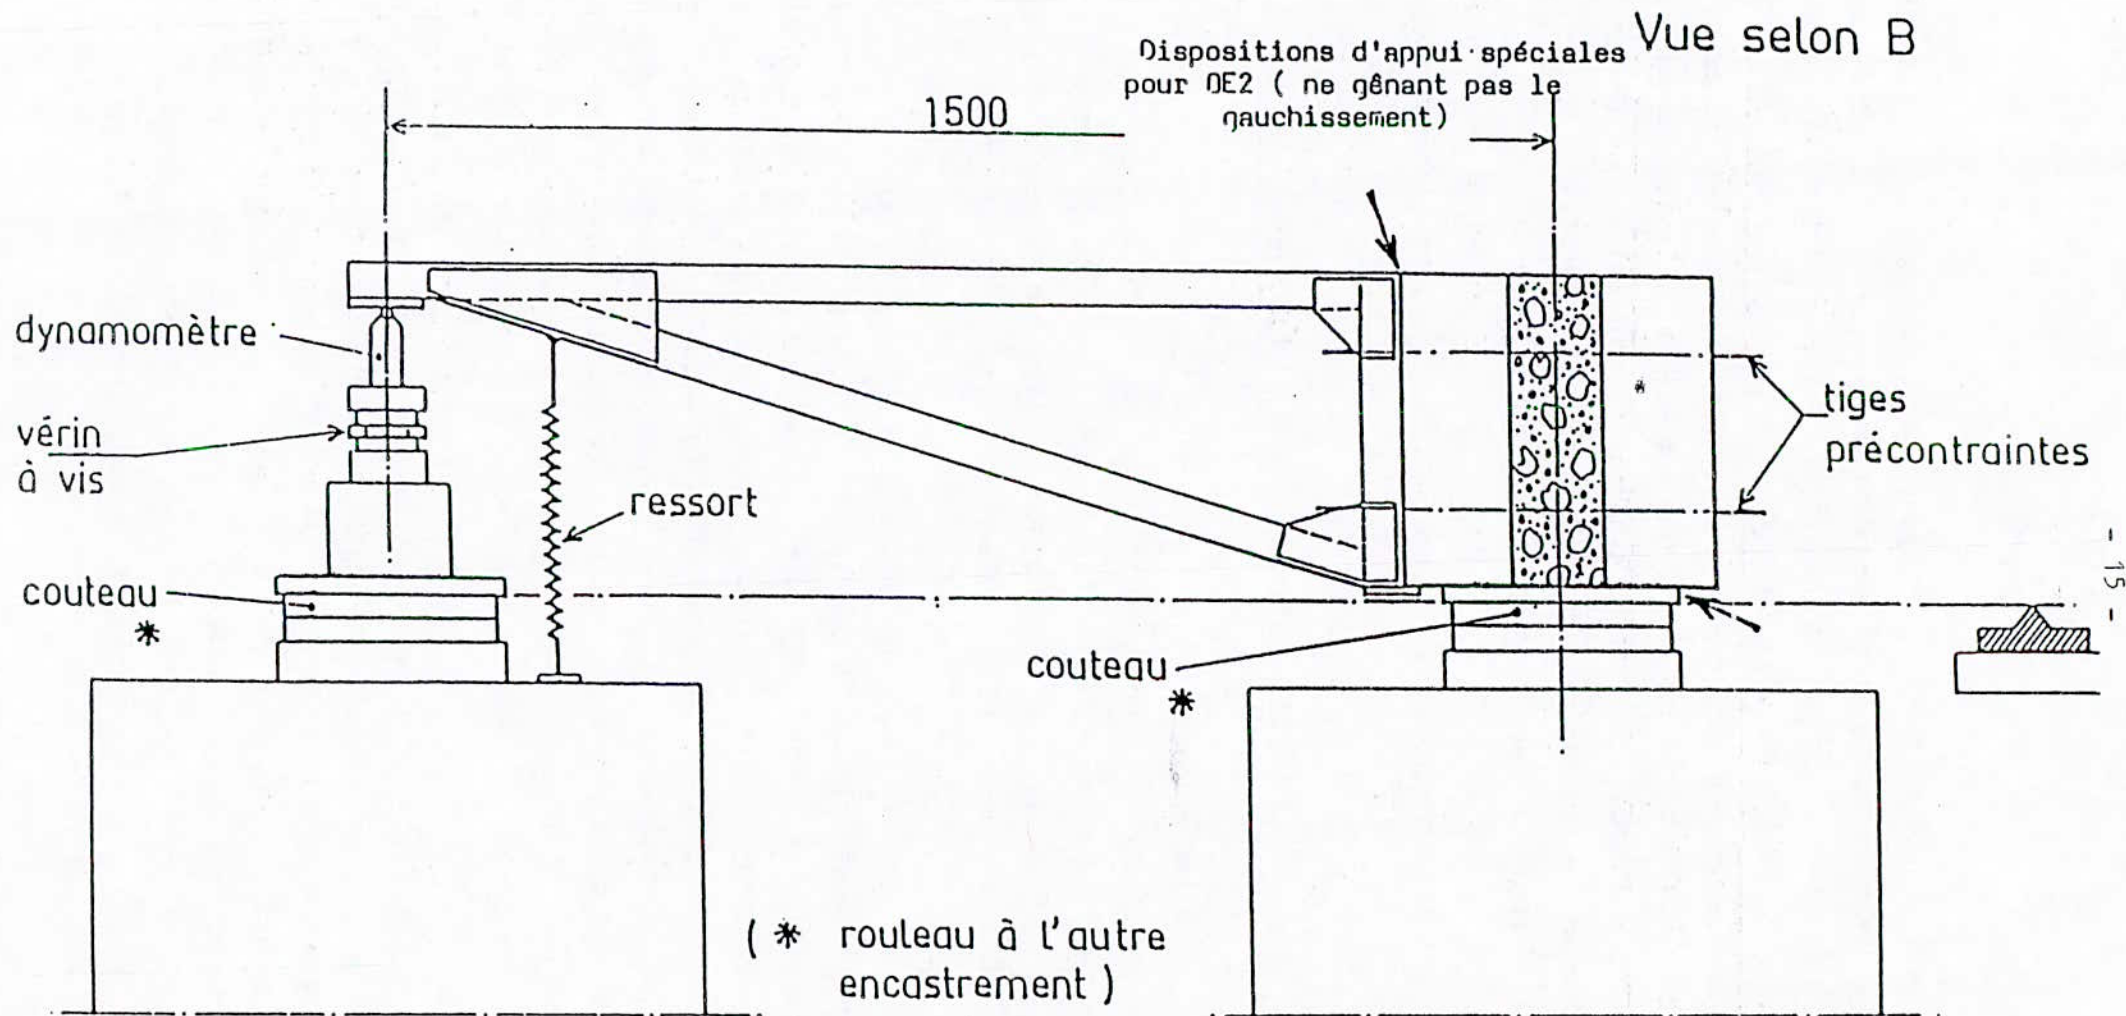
Dispositif d'essai; détail 2 : encastrement en torsion
